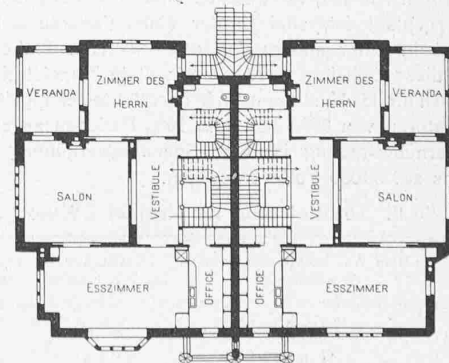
Grundriss vom Hauptgeschoss. — 1 : 400.
